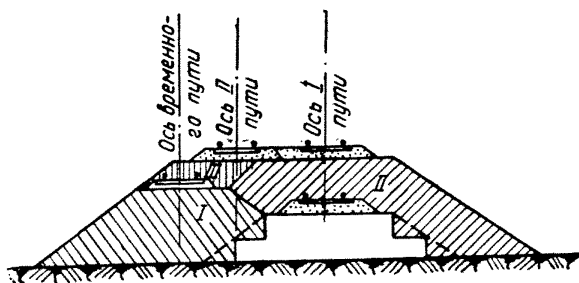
Схема отсыпки насыпи второго пути выше существующего без смещения оси первого пути
